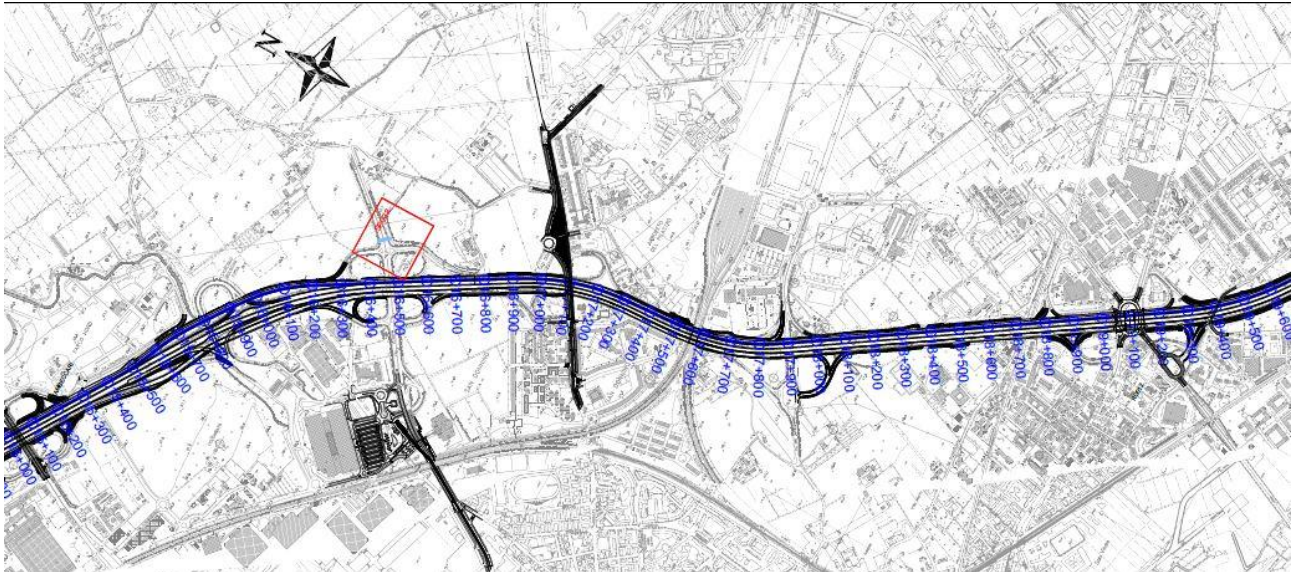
Planimetria dell'area di intervento (parte 3) (in rosso le principali opere connesse ricadenti nel Lotto 1).
